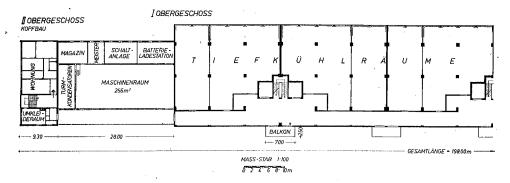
Grundrißausschnitt 1. Obergeschoß zu Bild 8.
